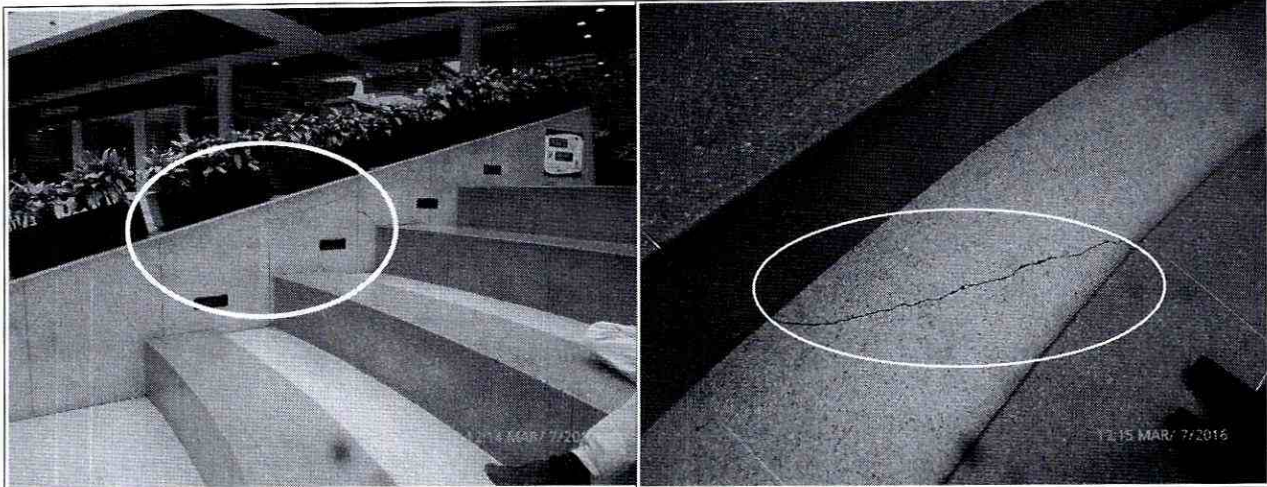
y 4. Fisuras de tendencia longitudinal de aberturas entre 2mm-3mm y longitudes de 0.5m – 1m, en el sector del primer nivel (plazoleta central de eventos).
